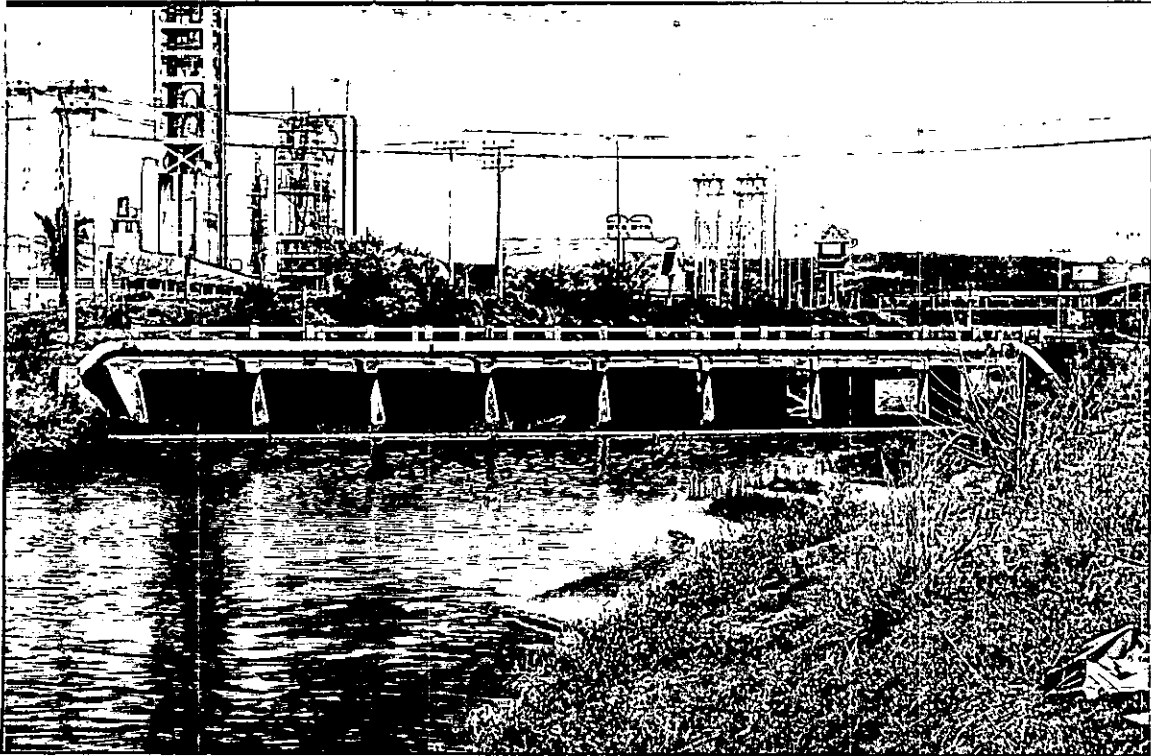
Arroyo Casimiro. Salida del culvert sobre la Via Mamonal.
